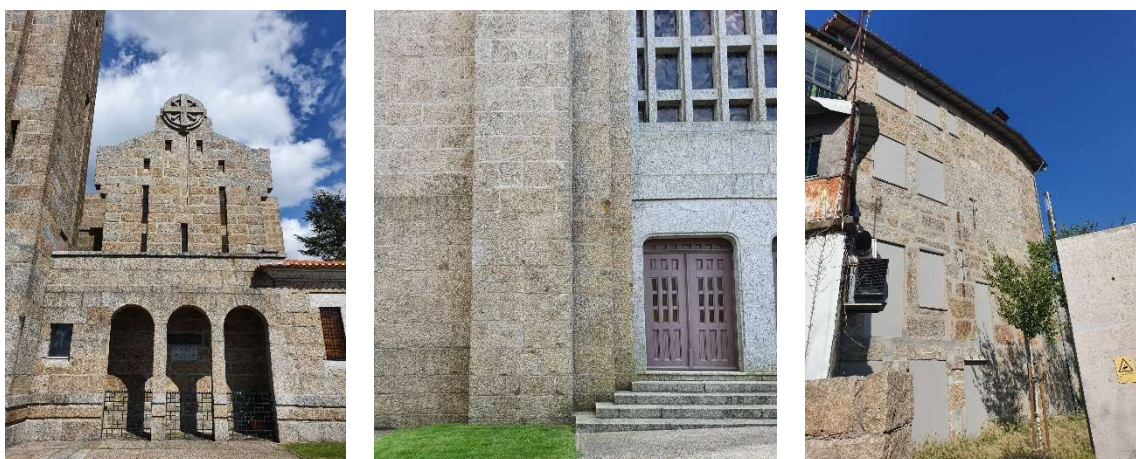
Construções em cantaria de pedra (Guimarães).
